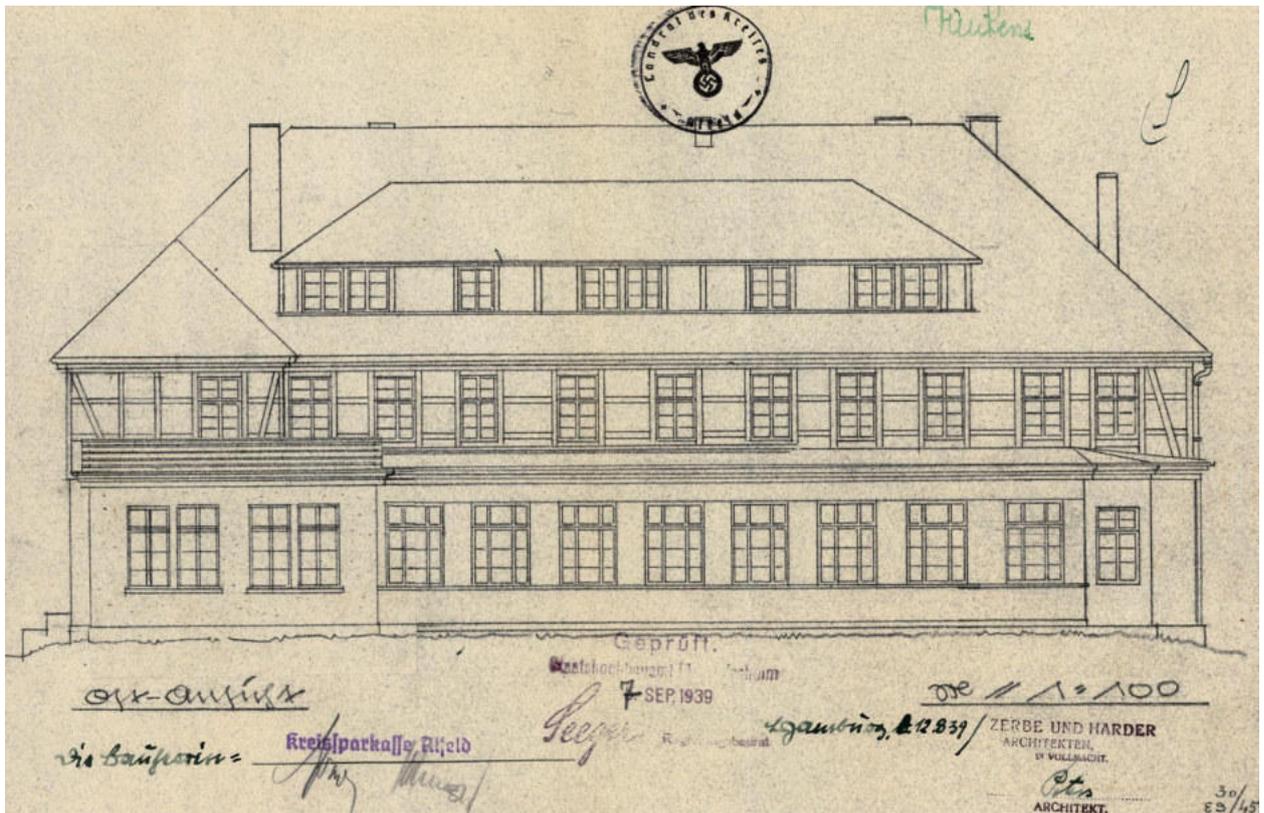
Planung Anbau 1939 (wie vor), Ostfassade mit dem nicht ausgeführten eingeschossigen Anbau (links). Der Dachgeschossausbau mit breiter Gaube ist bereits vorhanden und zeigt die heute noch bestehende Form.
